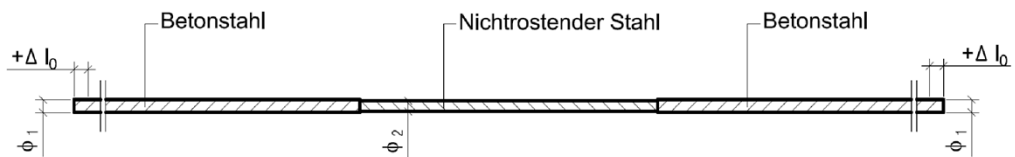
Druckelement aus Stahl mit beidseitig angeschweißtem Betonstahl, mit Durchmesserkombination, Tabelle A.1 gilt auch für dieses Druckelement aus Stahl
